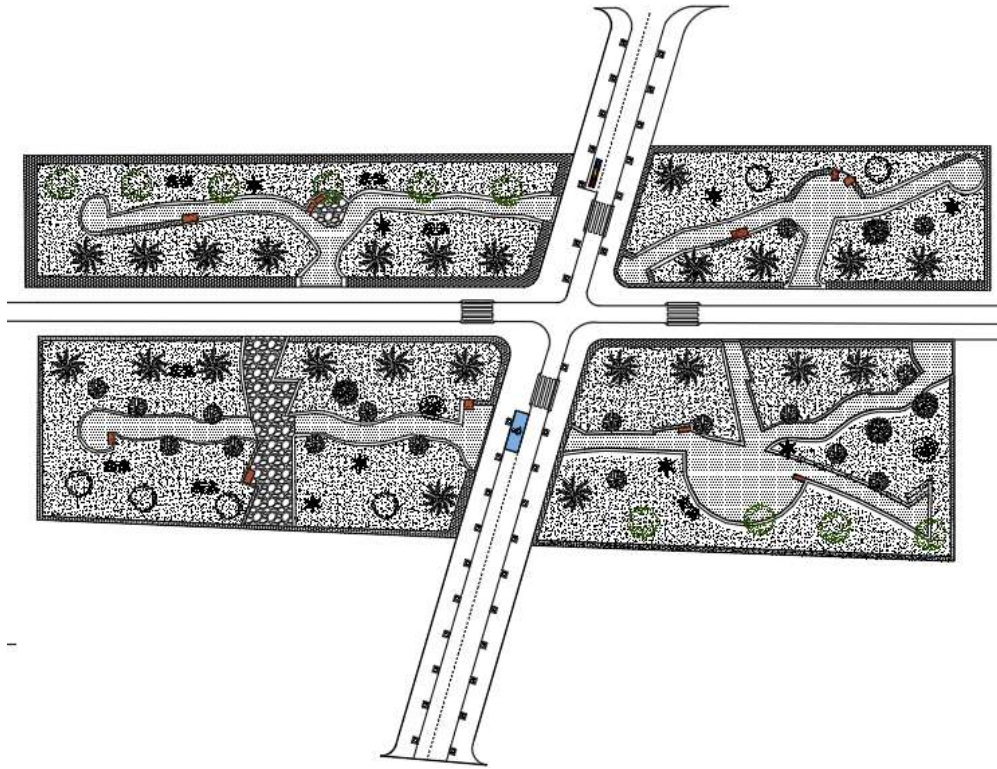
Plano de plantaciones en jardines. Fuente: AutoCAD.
